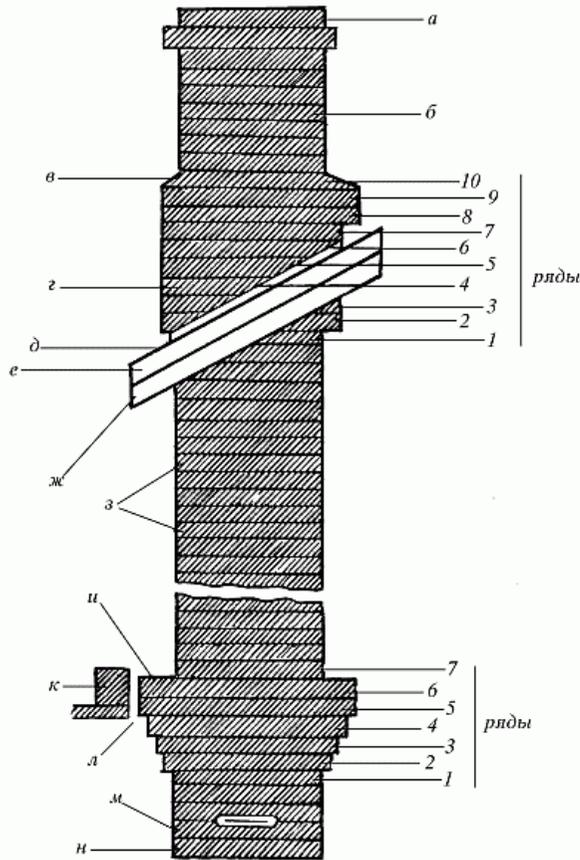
Устройство дымовой трубы: а — оголовок трубы; б — шейка трубы; в — цементный раствор; г — выдра; д — кровля; е — обрешетка; ж — стропила; з — стоек трубы; и — распушка; к — балка с перекрытием; л — изоляция; м — дымовая задвижка; н — шейка печи
